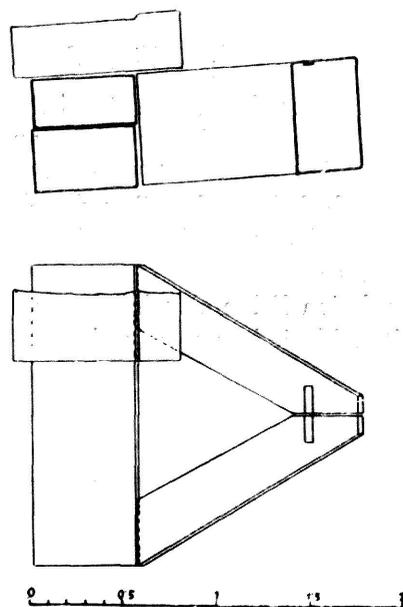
Grundriß und Schnitt durch die Kläranlage
